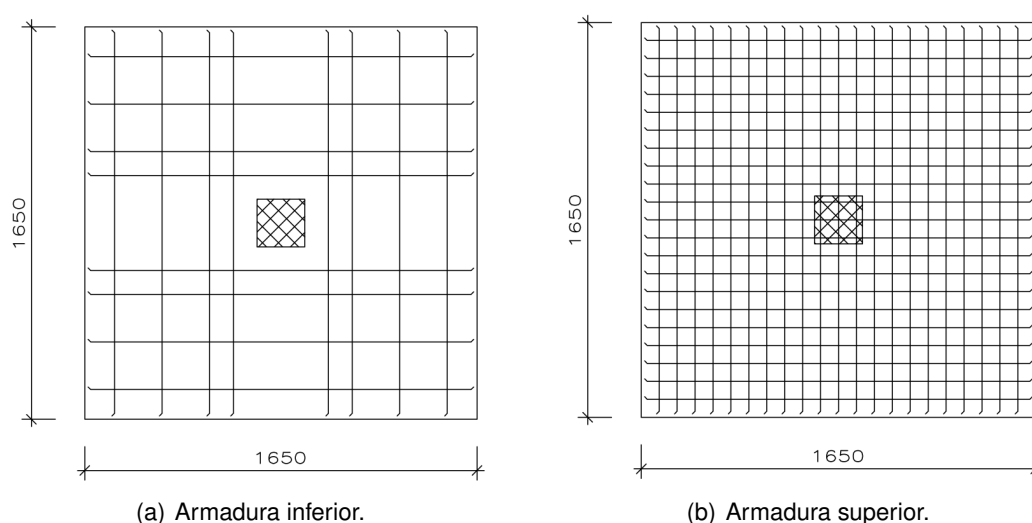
Armaduras longitudinais dos modelos (desenhos sem escala e dimensões em mm).
